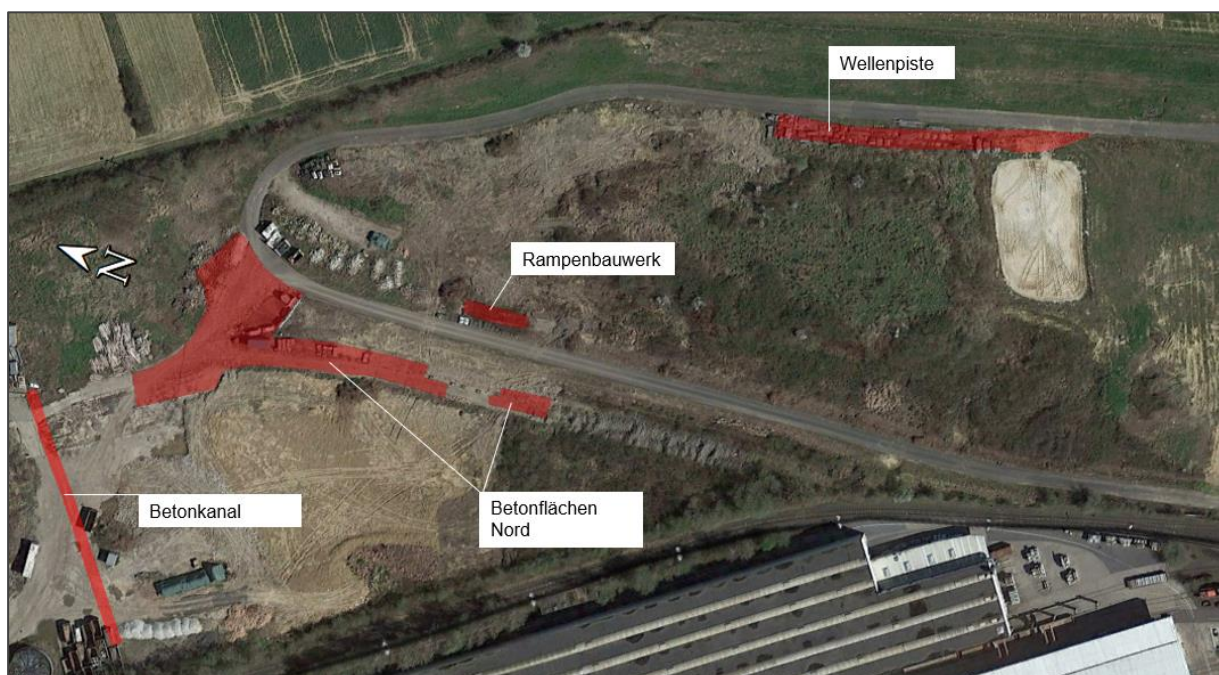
Lageskizze Betonflächen und -bauwerke
